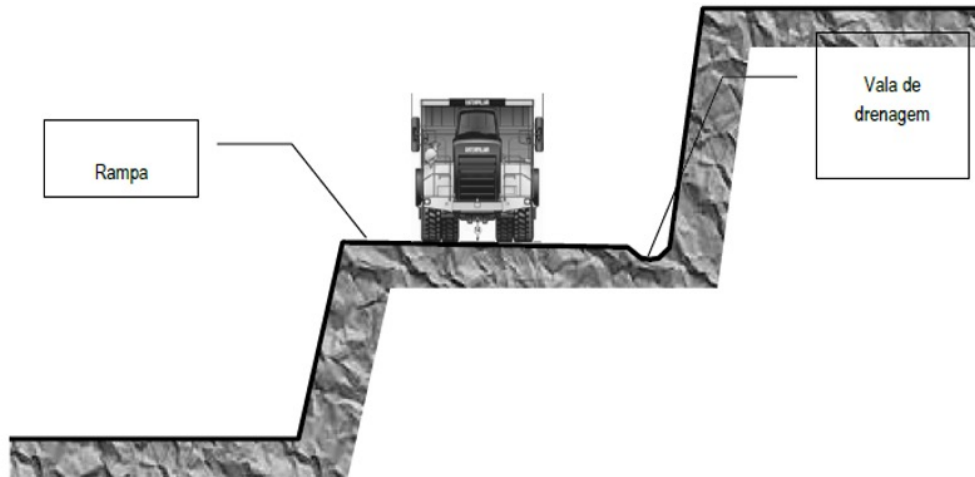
Perfil esquemático da implantação das valas de drenagem nas rampas.
